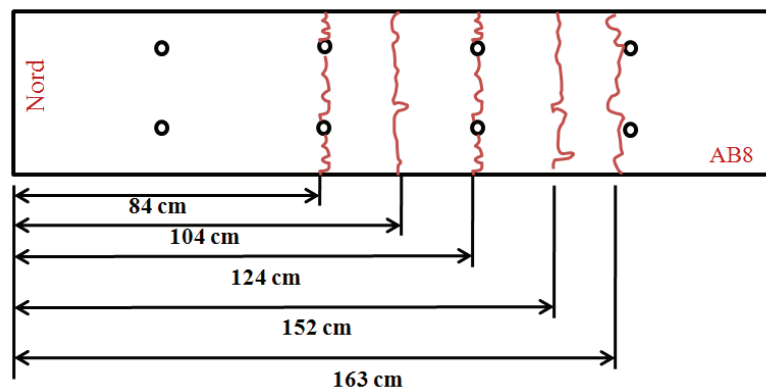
Relevé des fissures pour la poutre AB8
